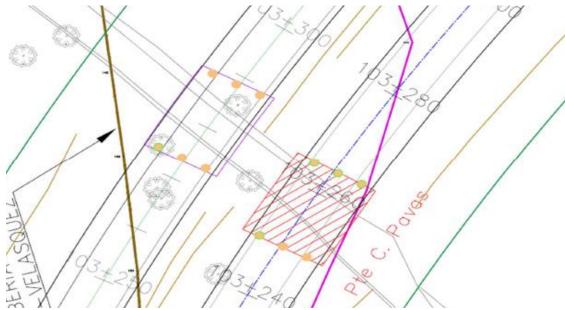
Acercamientos críticos con estructuras viales (Puentes) e infraestructura petrolera
